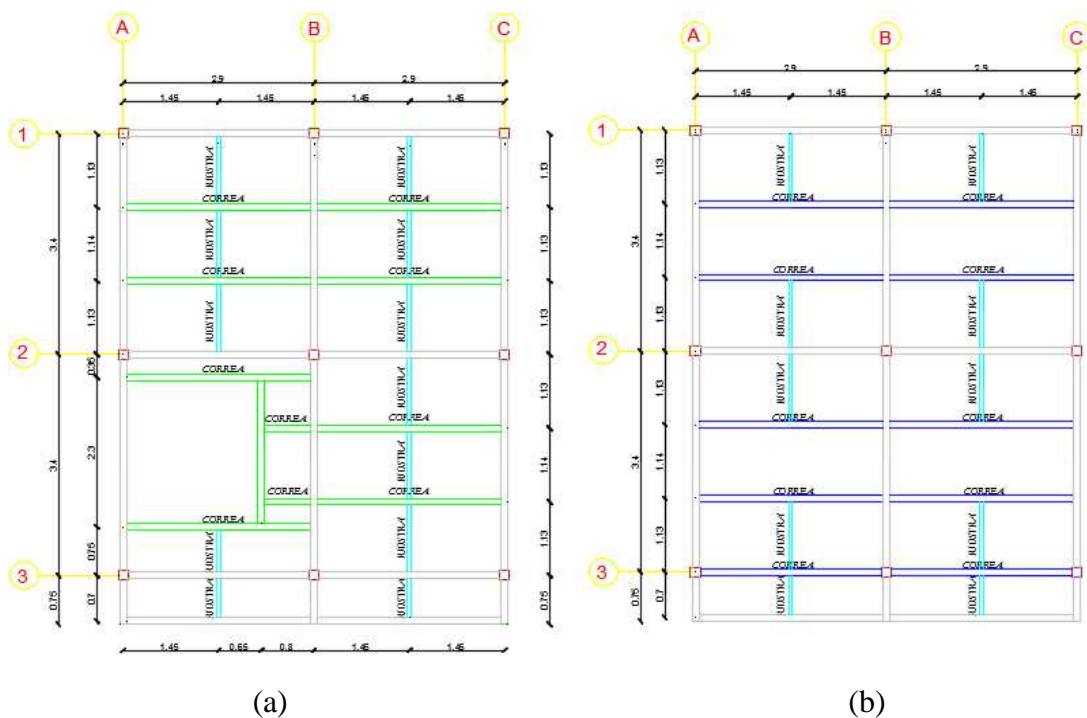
Asignación de correas en primera planta (a) y segunda planta (b)
